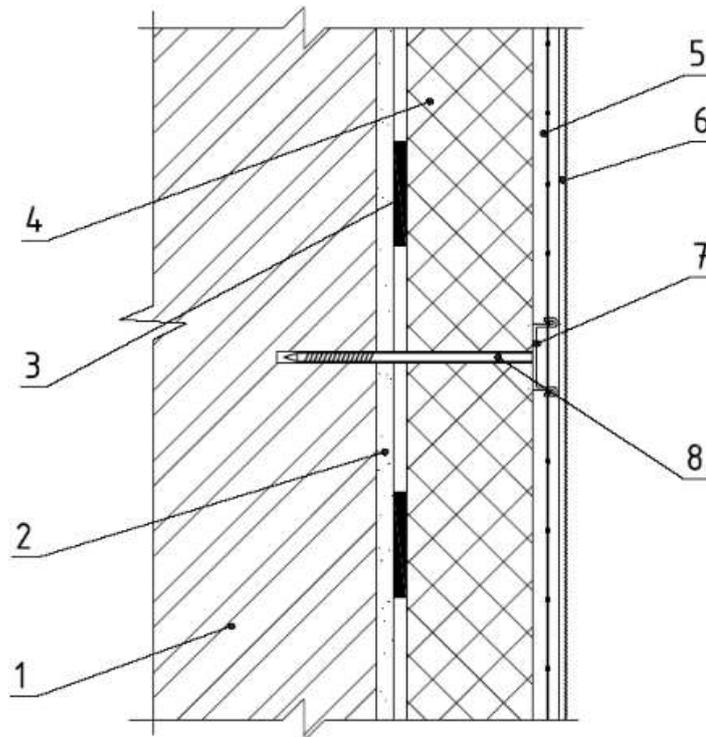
Схема утеплення з використанням товстошарової штукатурки для опорядження (1 – стіна; 2 – шар штукатурки; 3 – шар клею; 4 – шар утеплювача; 5 – захисний шар; 6 – зовнішнє опорядження; 7 – фіксатор для сітки армування; 8 – механічне кріплення)
